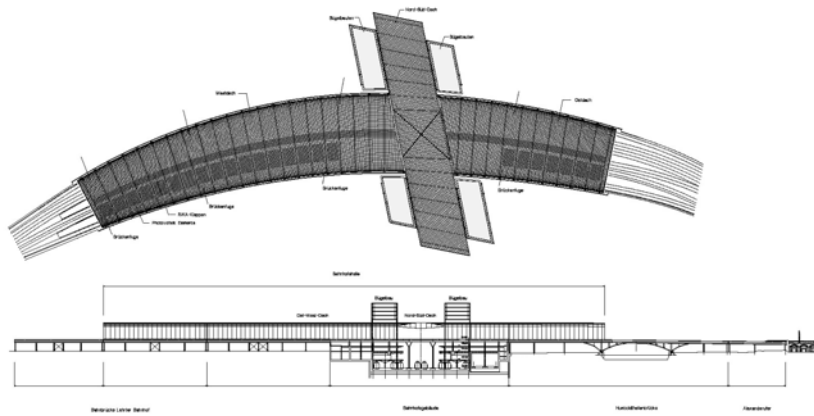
Grundriss und Ansicht der Gesamtmaßnahme
